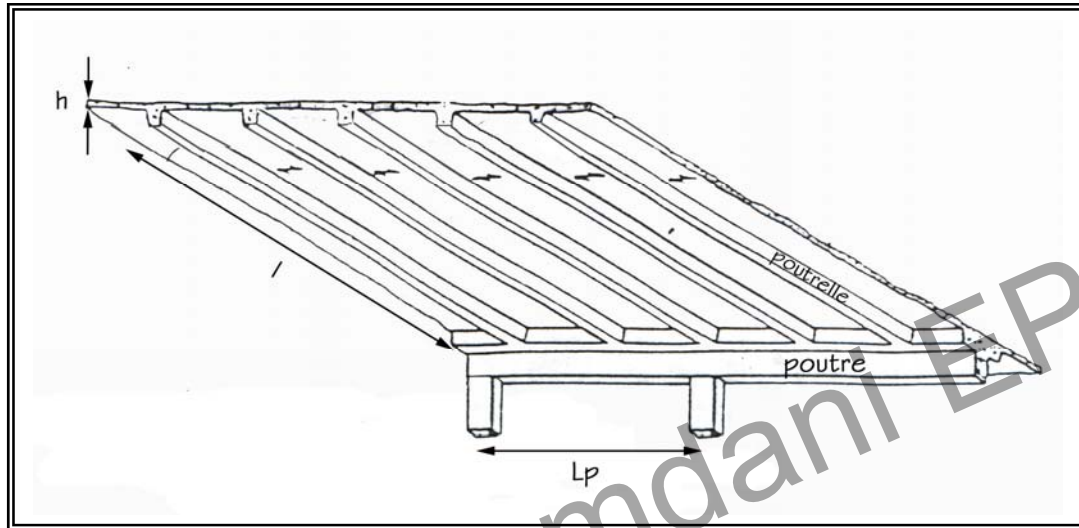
Dalles à répartition unidirectionnelle sur poutrelles.
